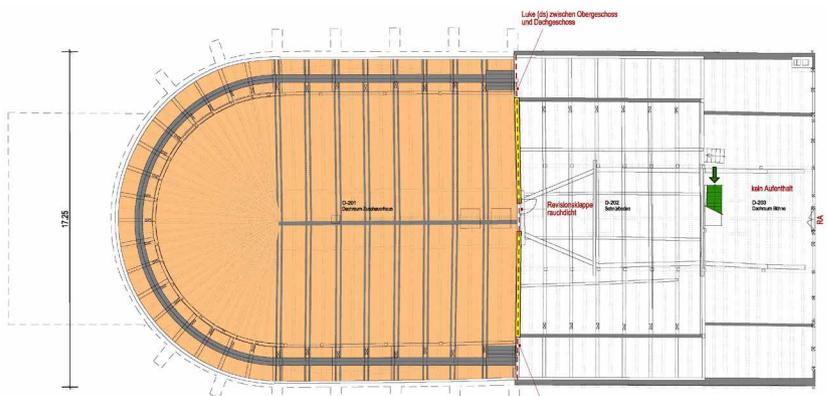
Grundriss Dachgeschoss [13]
